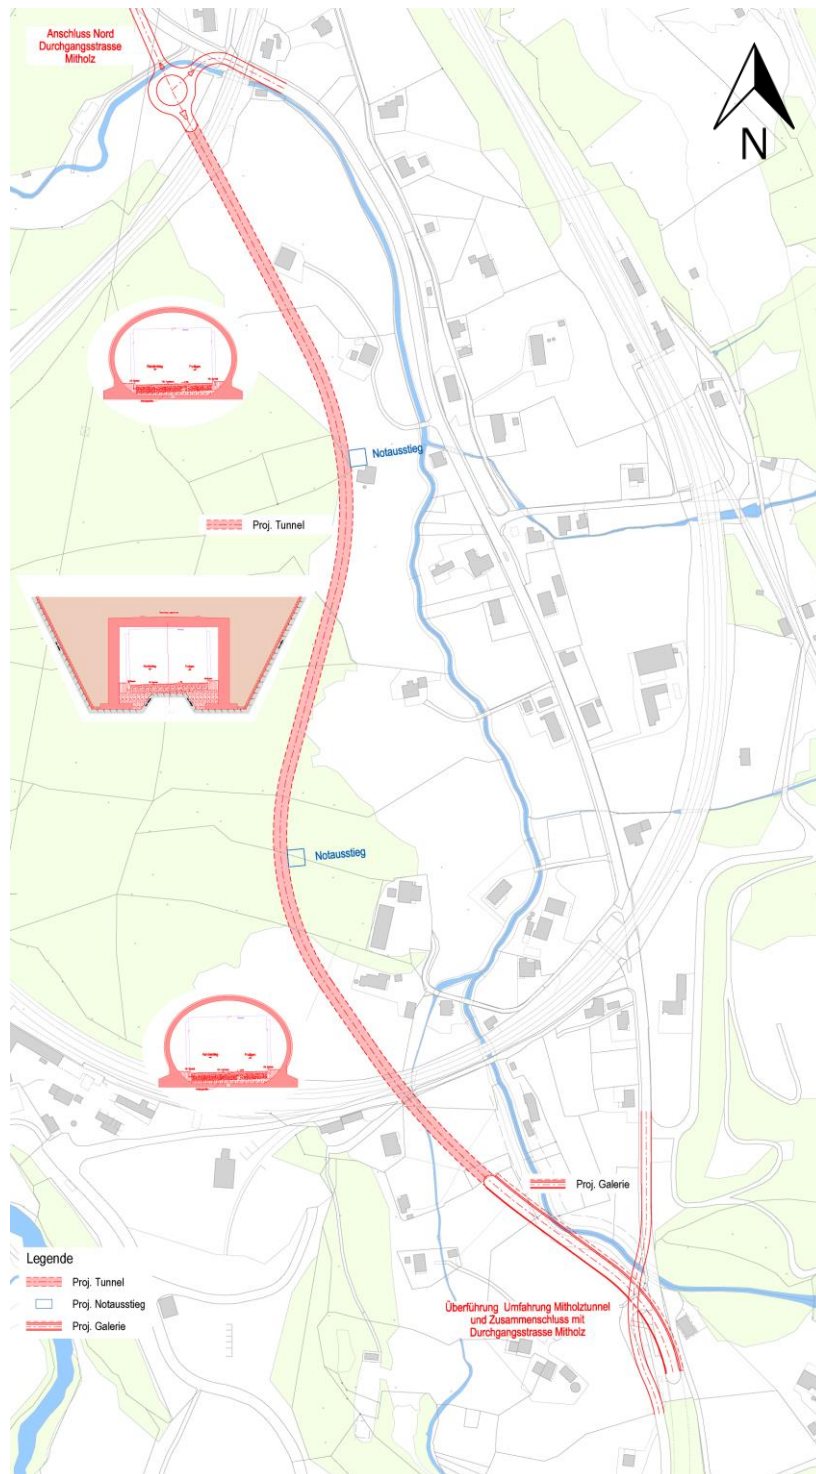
Linienführung Variante b - Verlängerung Tunnel Mitholz – im Anschluss an den Tunnel Mitholz wird der erste Abschnitt mittels einer Galerie gelöst, um auf eine Ereignislüftung verzichten zu können.
